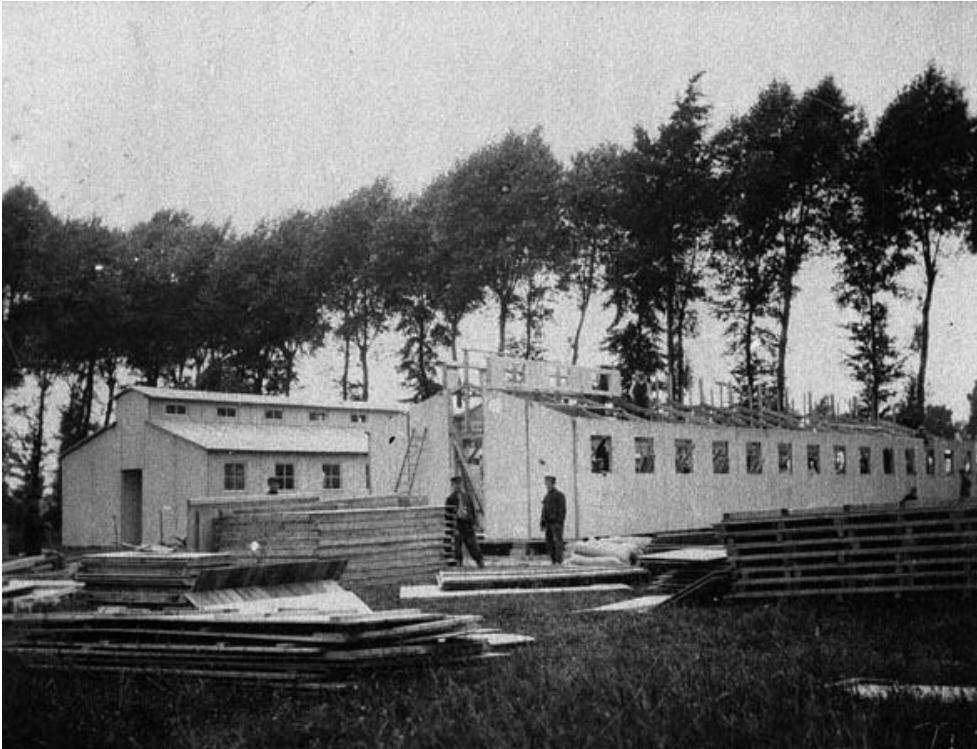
Pavillon en voie d'achèvement - infirmerie divisionnaire - Forthem, juillet 1915 (Koninklijk Museum van het Leger en de Krijgsgeschiedenis Brussel, Fotocollectie, Fortem, juli 1917).
